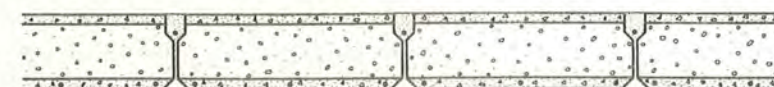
Jernbeton- og spændbetondæk, snit 1:20
